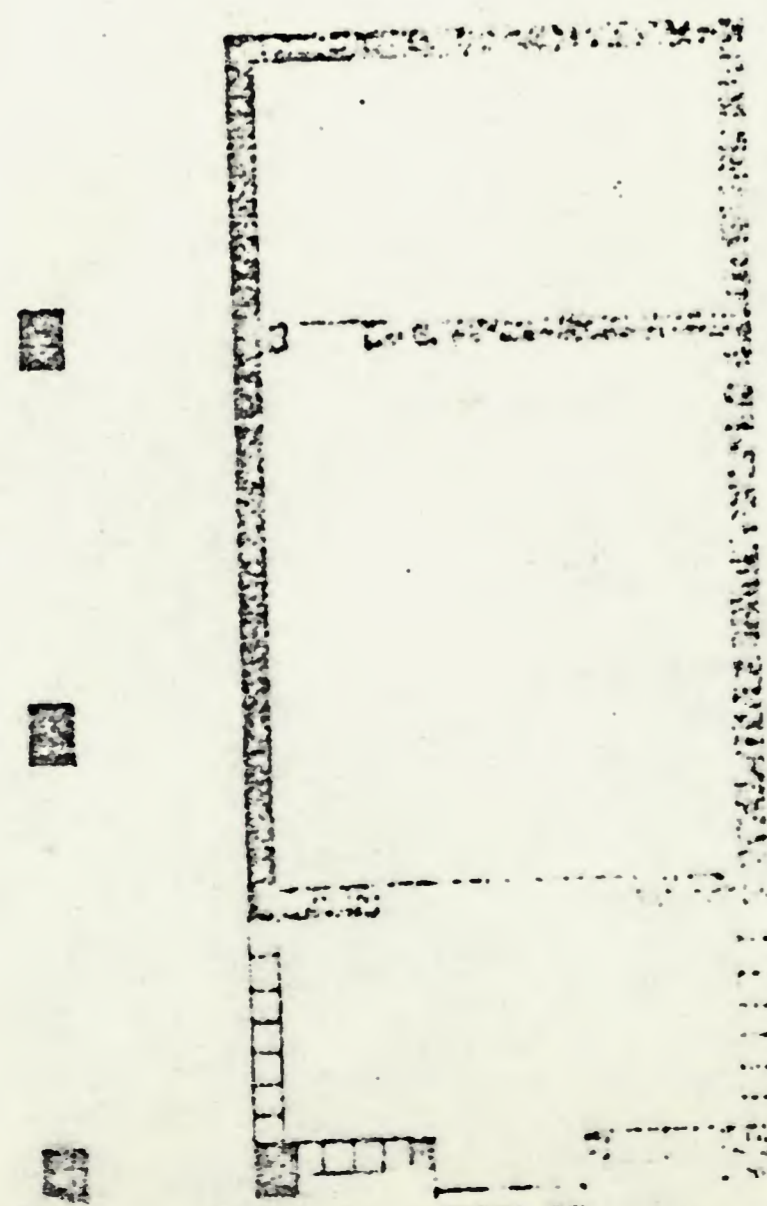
Planta da Capela de Santa Cruz do Bairrinho. Croqui do Autor.
